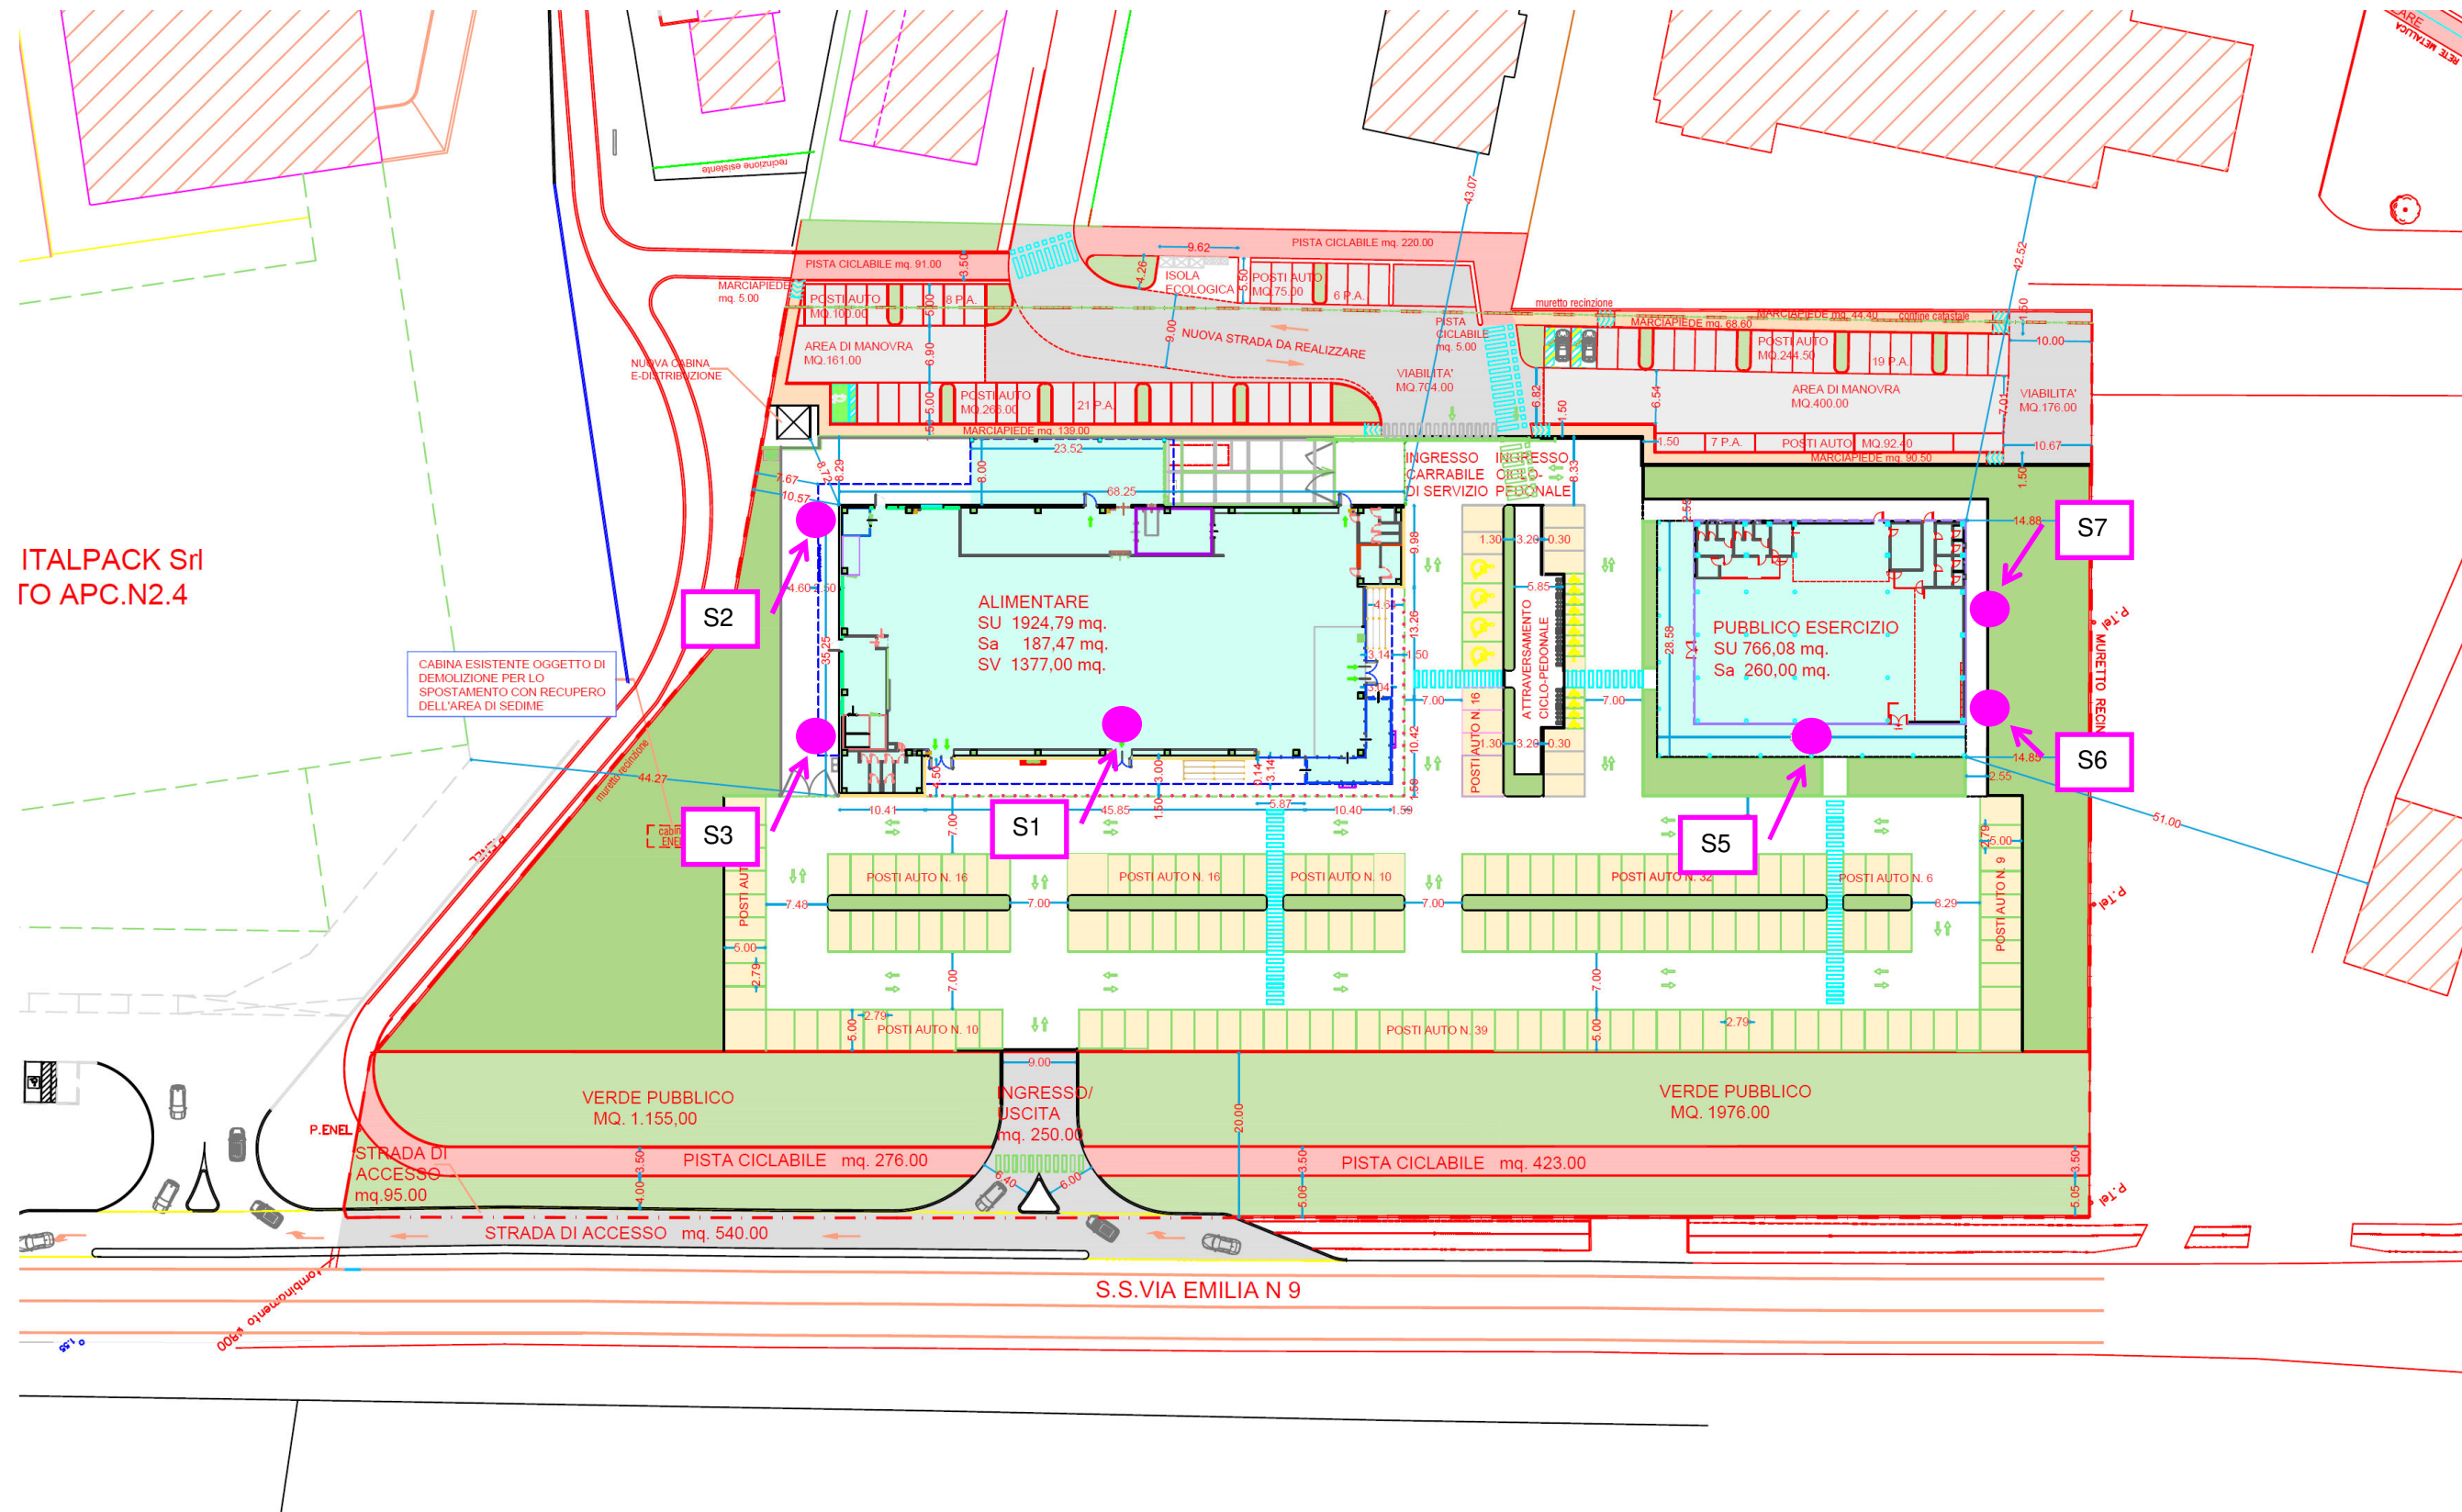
Planimetria con localizzazione delle sorgenti sonore esterne
